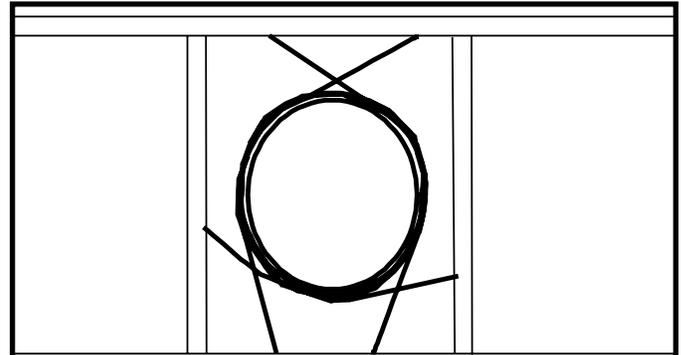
Sujeción de las secciones verticales del tubo de escape
